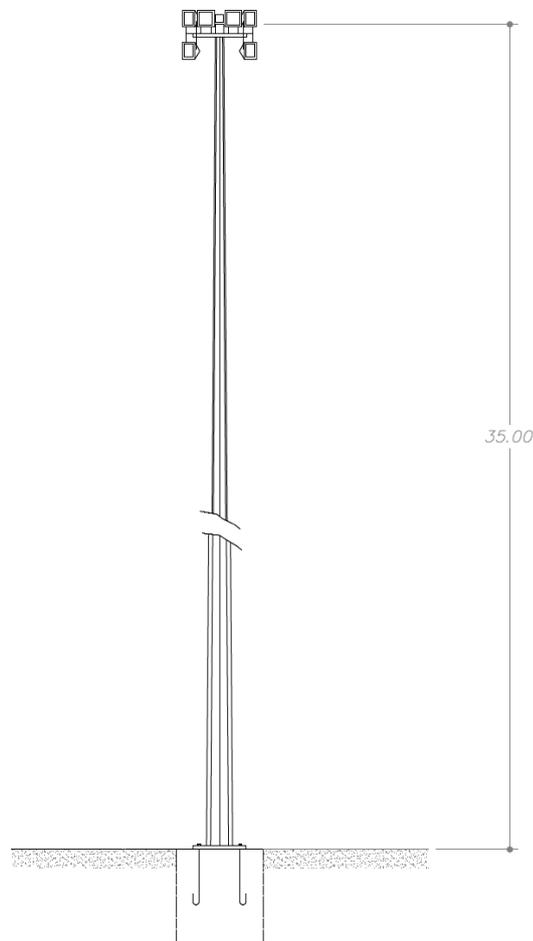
Tipologico torre faro per l'illuminazione di impianto.
